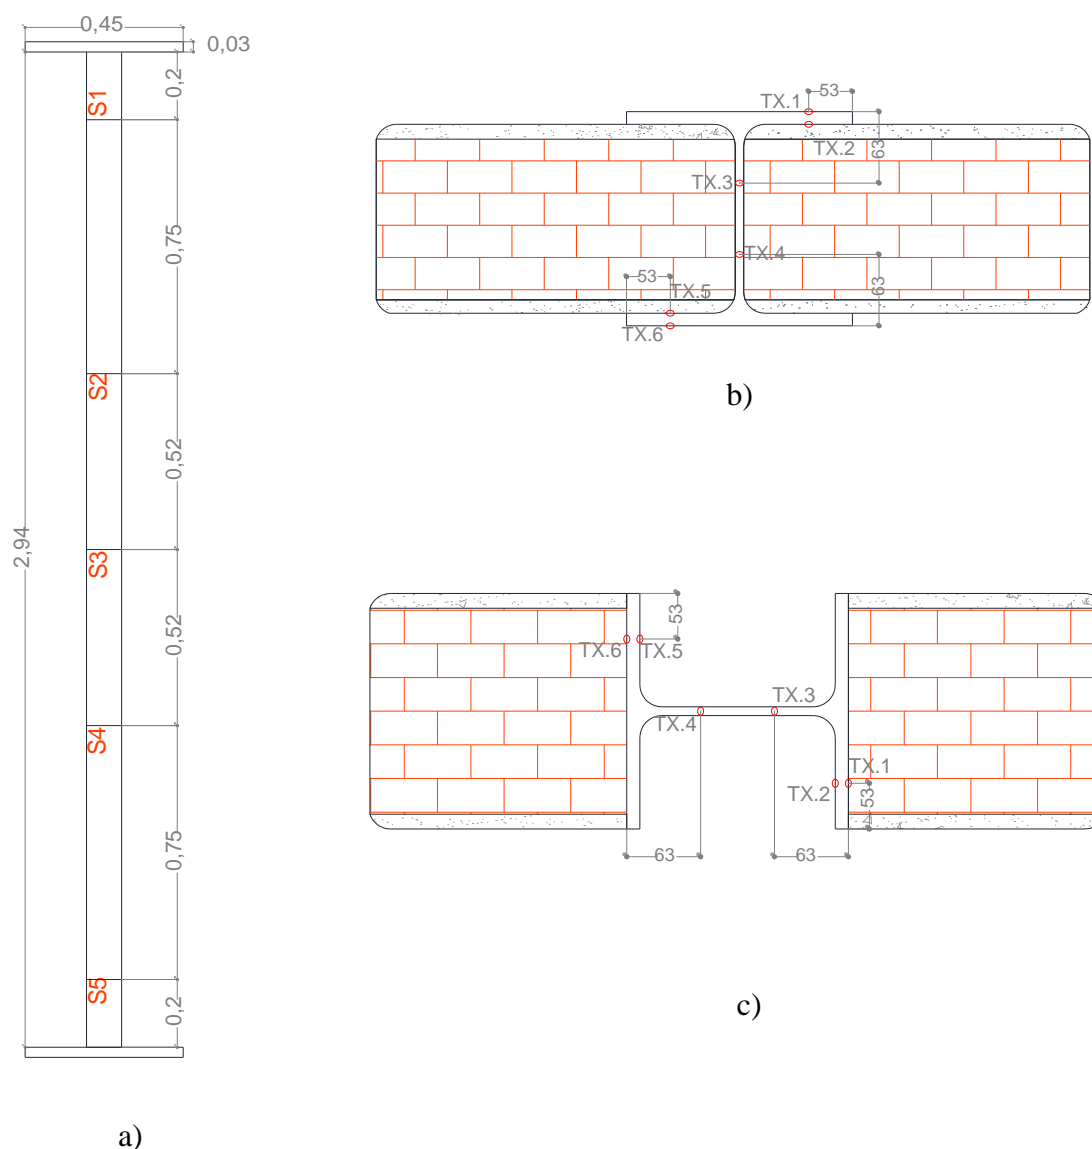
Provetes de ensaio com localização dos termopares a) vista lateral b) secção transversal com perfil tendo a alma perpendicular à parede c) secção transversal com perfil tendo a alma paralela à parede
